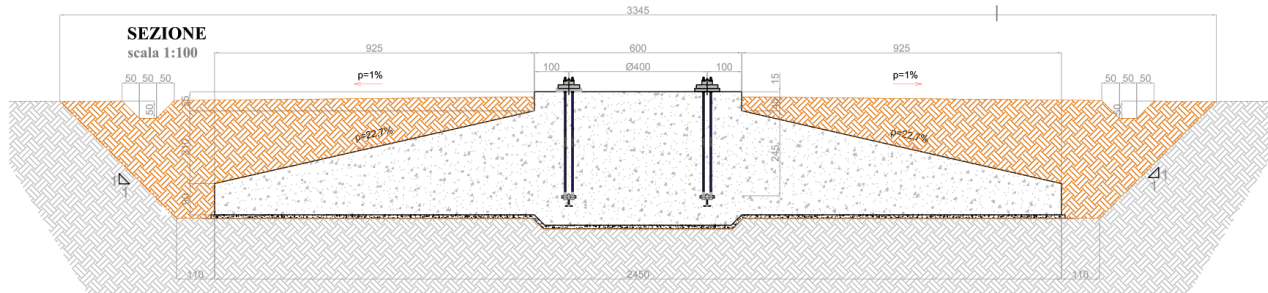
Geometria della fondazione diretta dell'aerogeneratore
